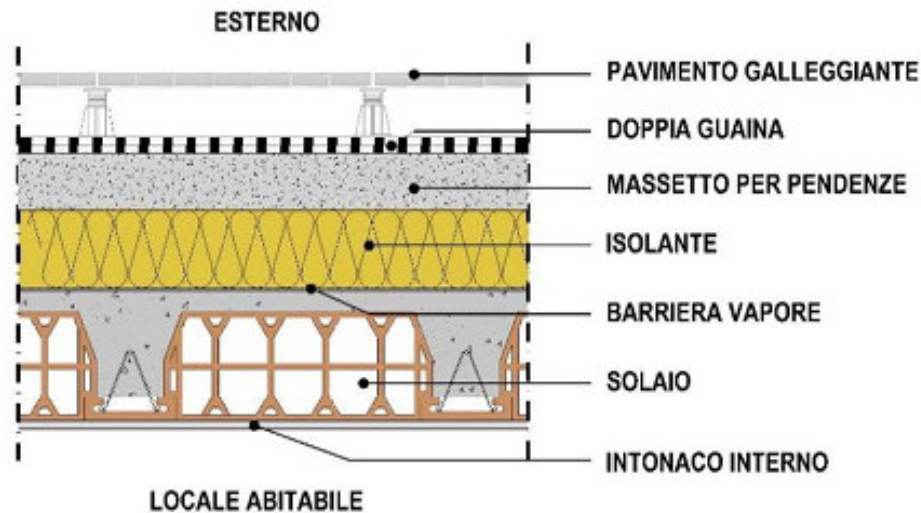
Tipologia di solaio di copertura con pavimento galleggiante
